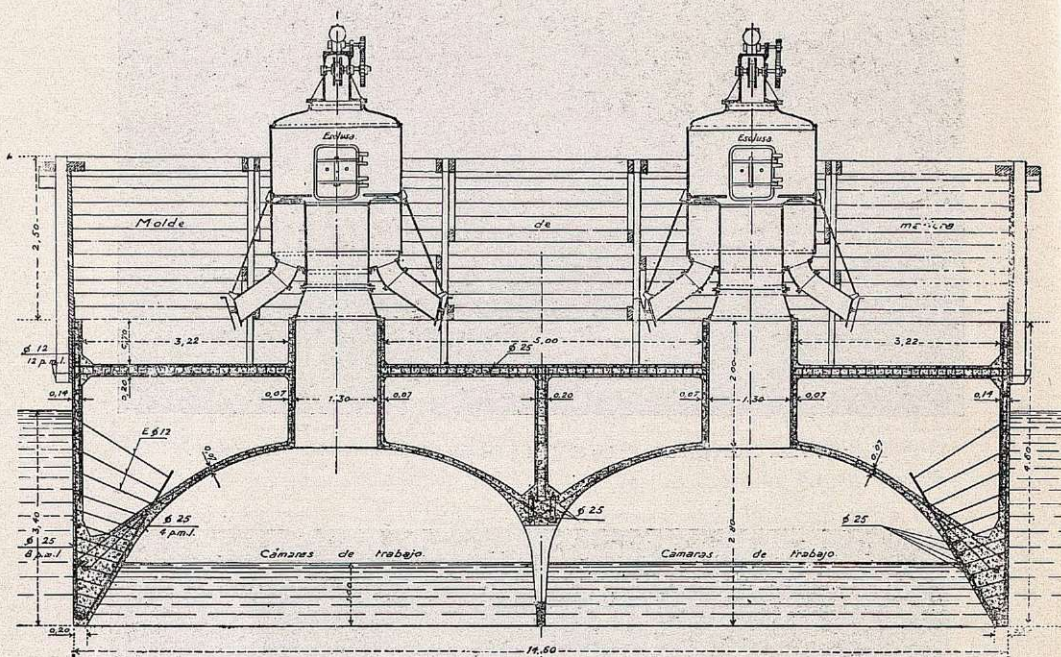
Cajón del puente de San Telmo (Sevilla). Sección longitudinal.
